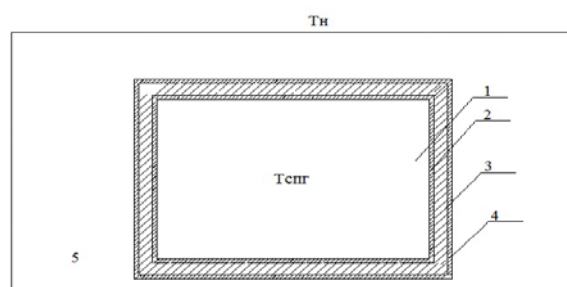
Схема поперечного сечения зоны расположения подземного резервуара для хранения сжиженного газа: 1 – внутренняя область резервуара; 2 – внутренняя стенка резервуара; 3 – теплоизоляционный слой; 4 – наружная стена, выполненная из предварительно напряженного железобетона; 5 – грунт; T_n – температура наружного воздуха; $T_{снз}$ – температура сжиженного природного газа;
